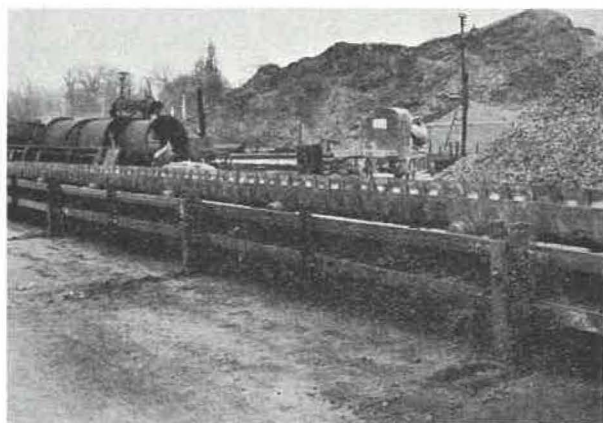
Vue latérale du convoyeur. Vue des supports et longerons.
